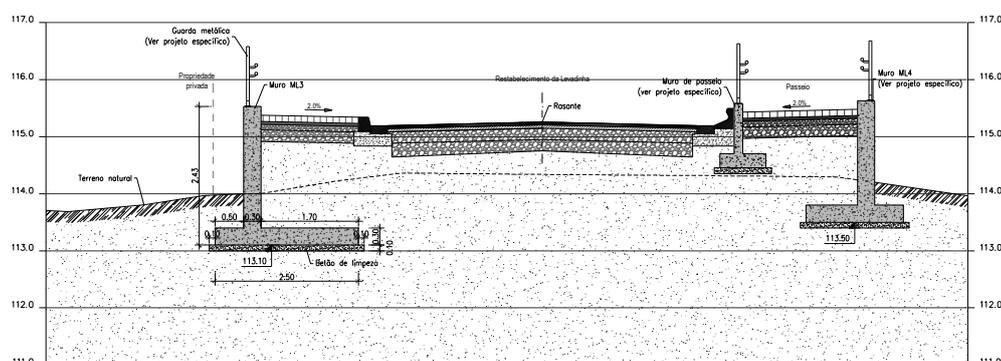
Perfil Transversal ao KM 0+012,00 dos dois muros (ML3 e ML4)
